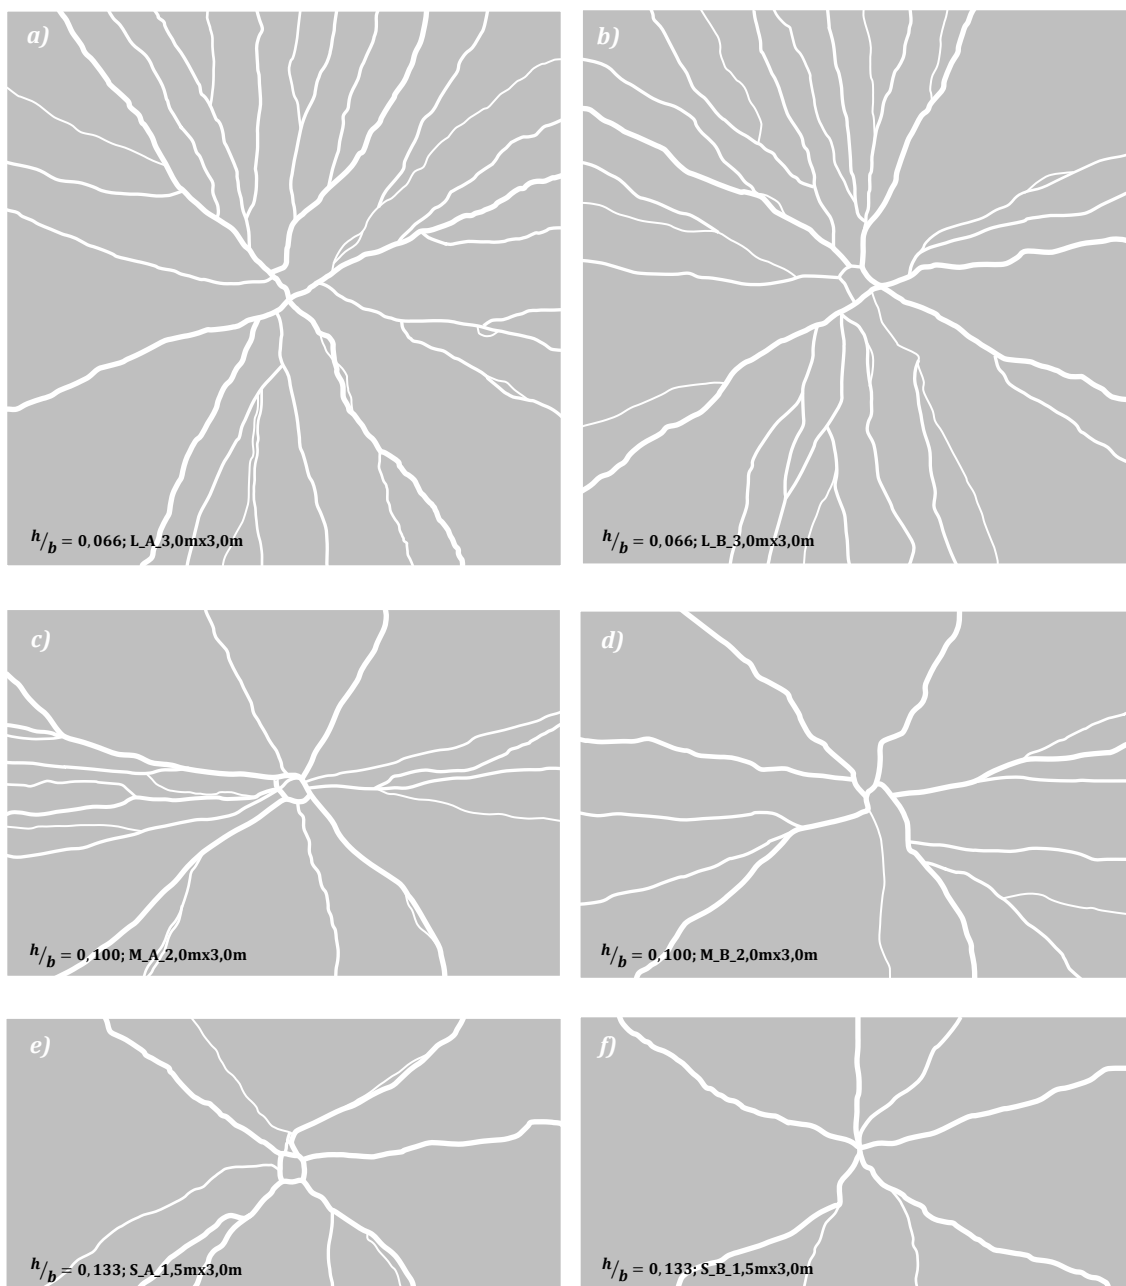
Mapas de fisuración de las losas tras el ensayo.
